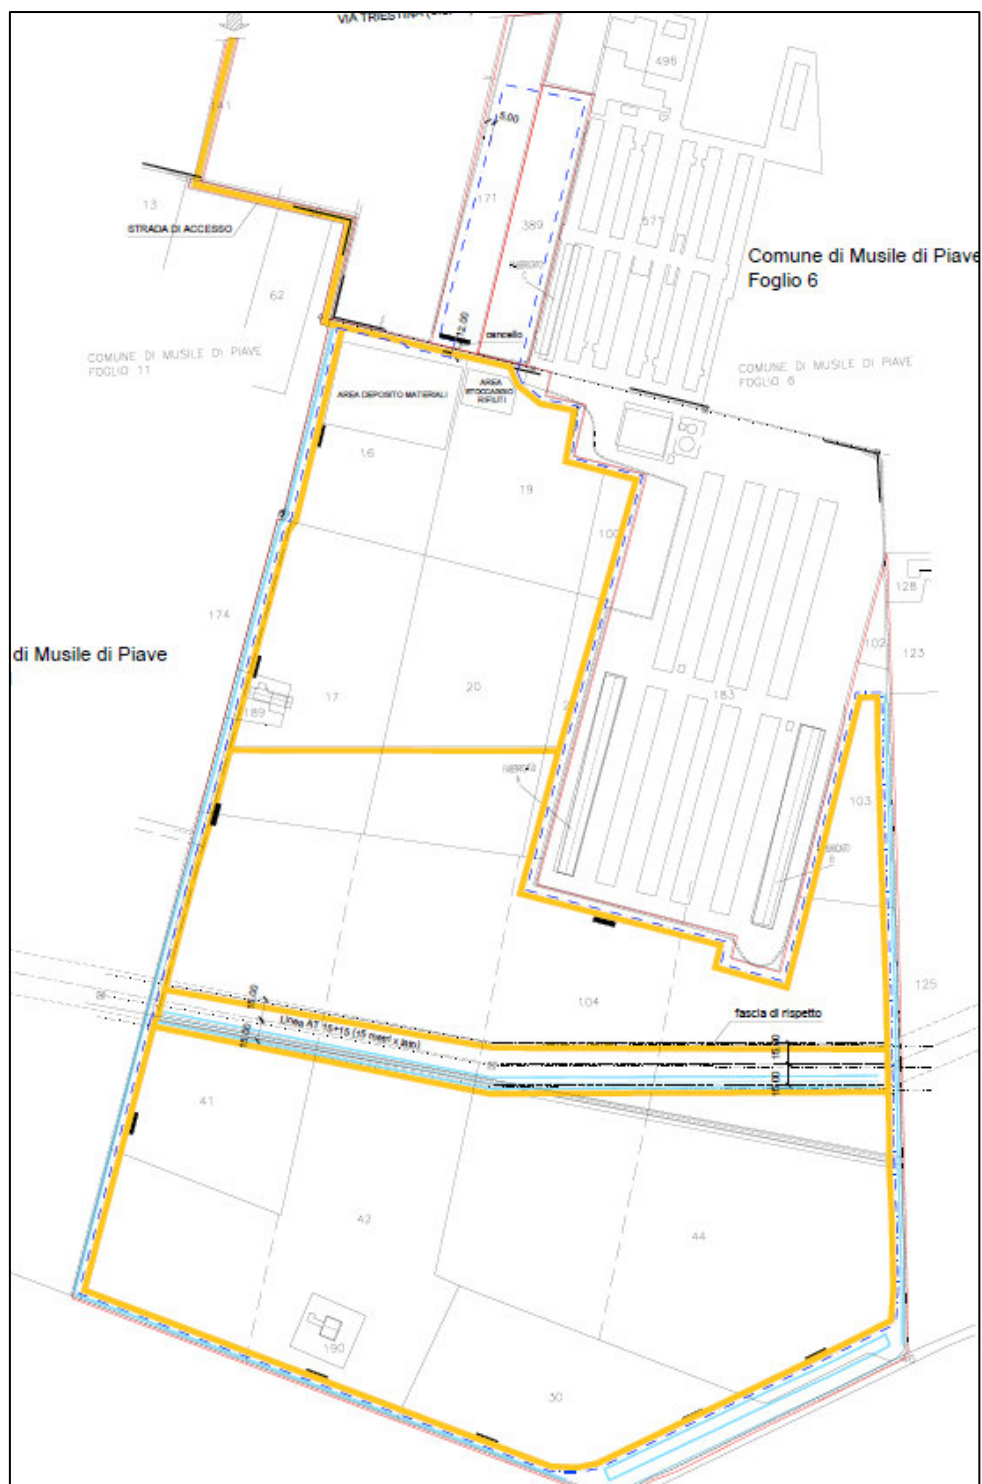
Planimetria di cantiere; in arancione la viabilità di cantiere, mantenuta anche in fase di esercizio dell'impianto a fini manutentivi
